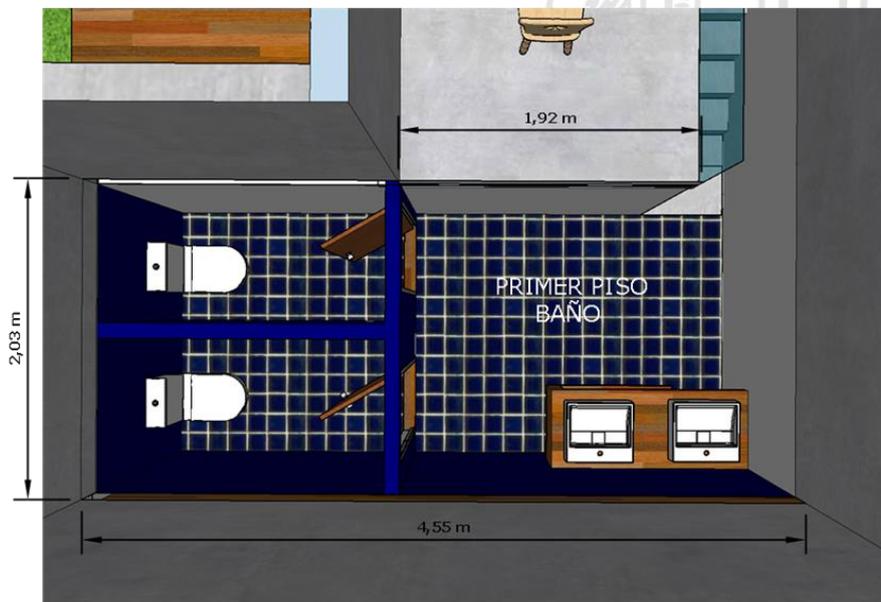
Baño en zona de recreación. Vista en planta. Fuente: Sketchup
